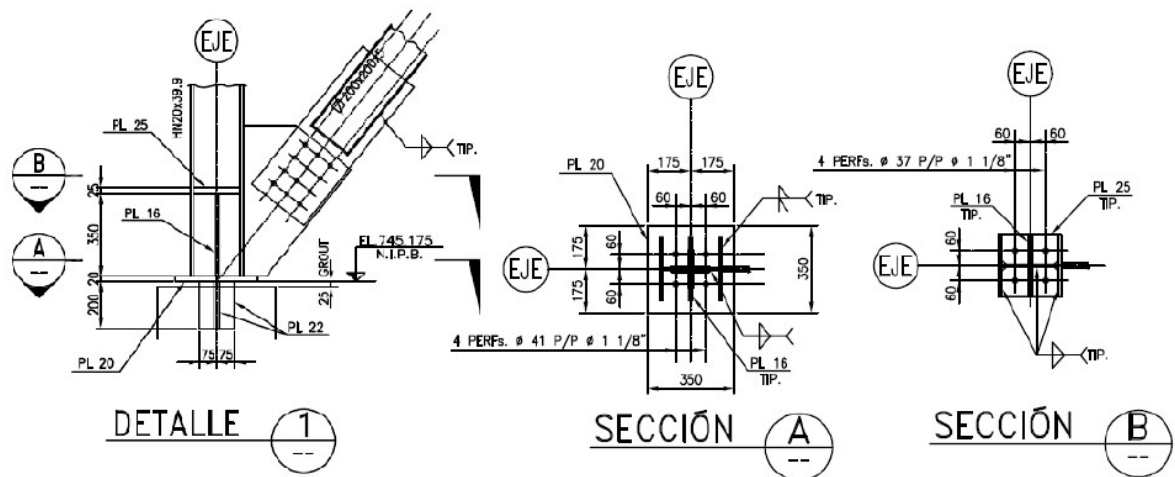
Detalle del anclaje de las columnas sismorresistentes para la Estructura 1.
